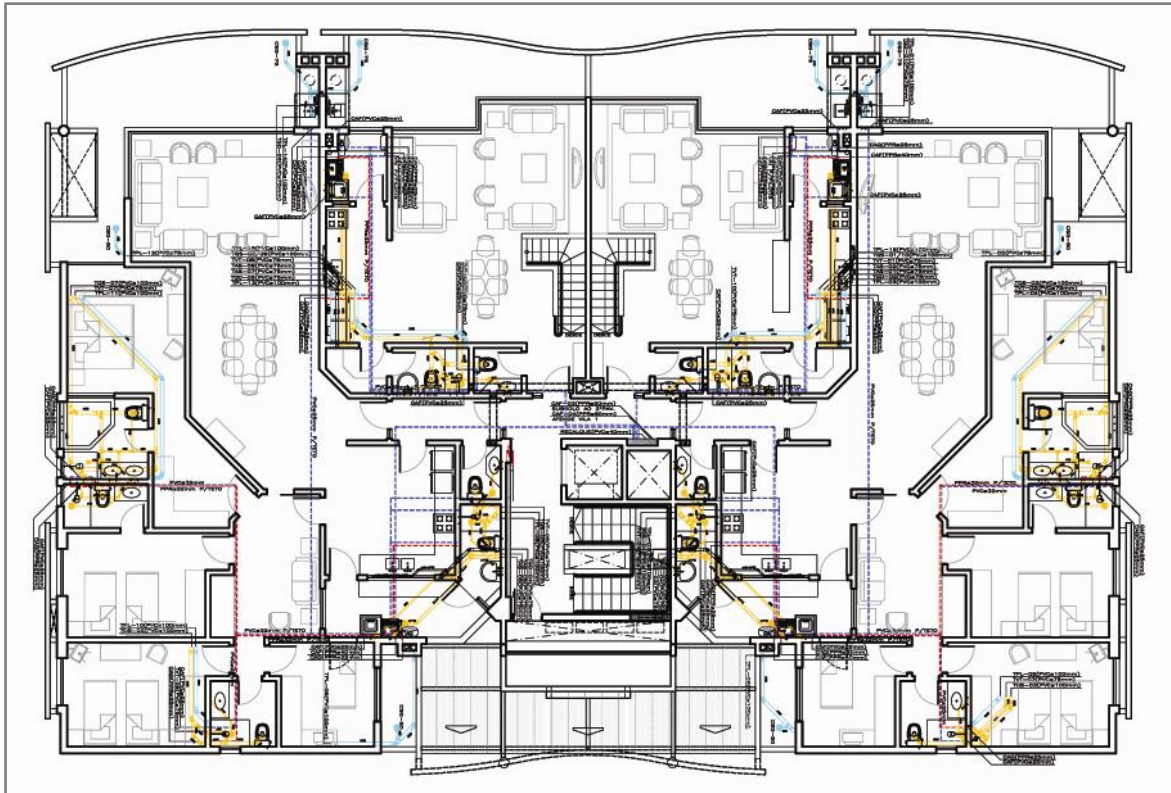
Planta baixa do projeto hidro-sanitário do pavimento tipo do bloco 02.
